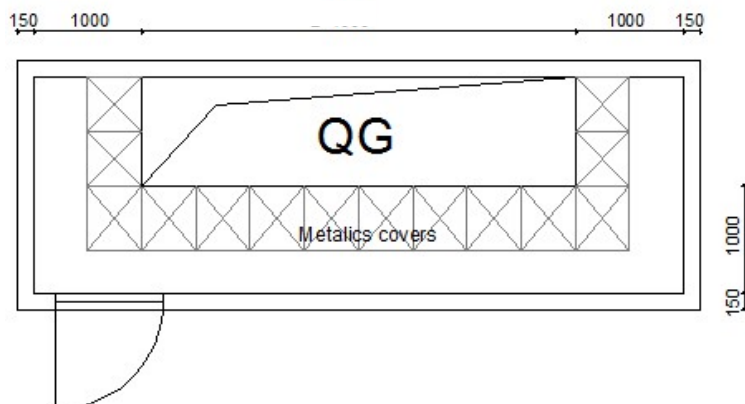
Dimensões mínimas para instalação de um quadro geral para instalações colectivas com ligação de acesso frontal.
